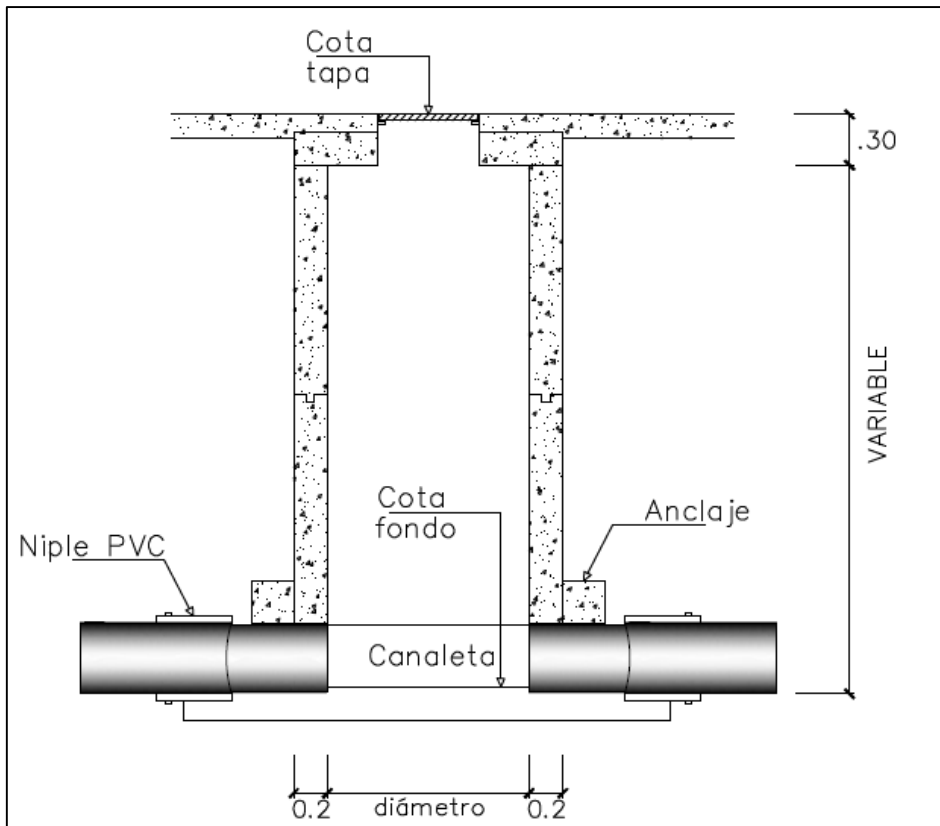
Buzón de Alcantarillado – Sección transversal
